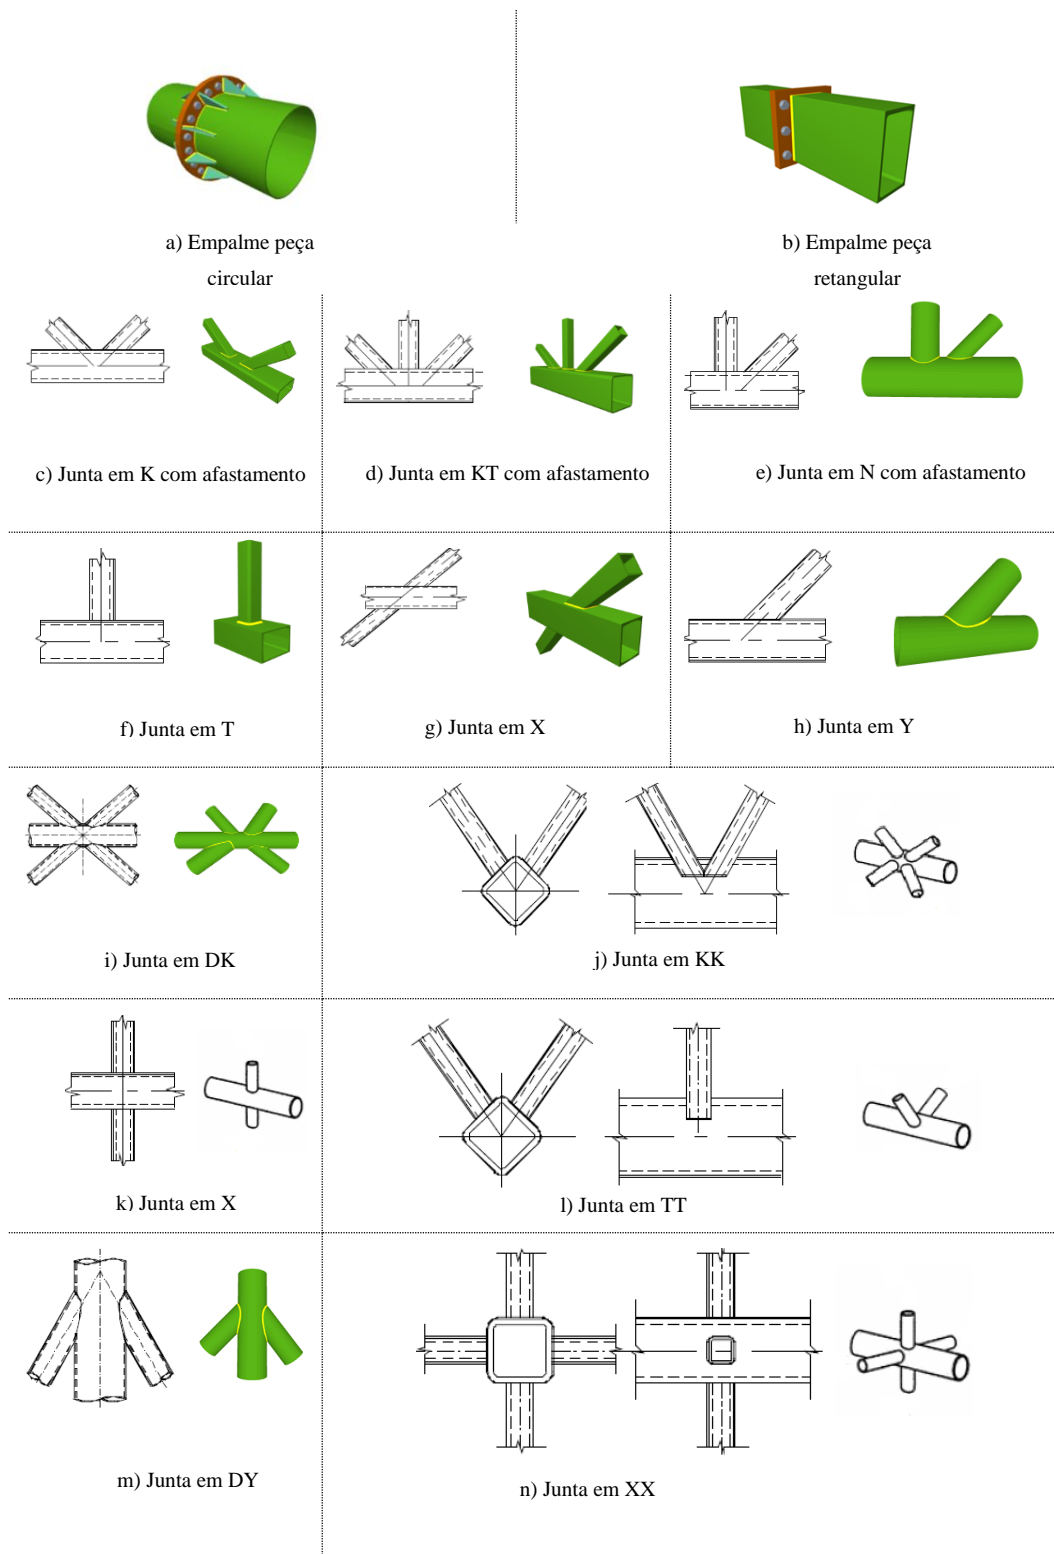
Tipos de juntas em vigas reticuladas de seção tubular (CEN, 2010a; CYPE, 2012; adaptado de Santos, 2003).
